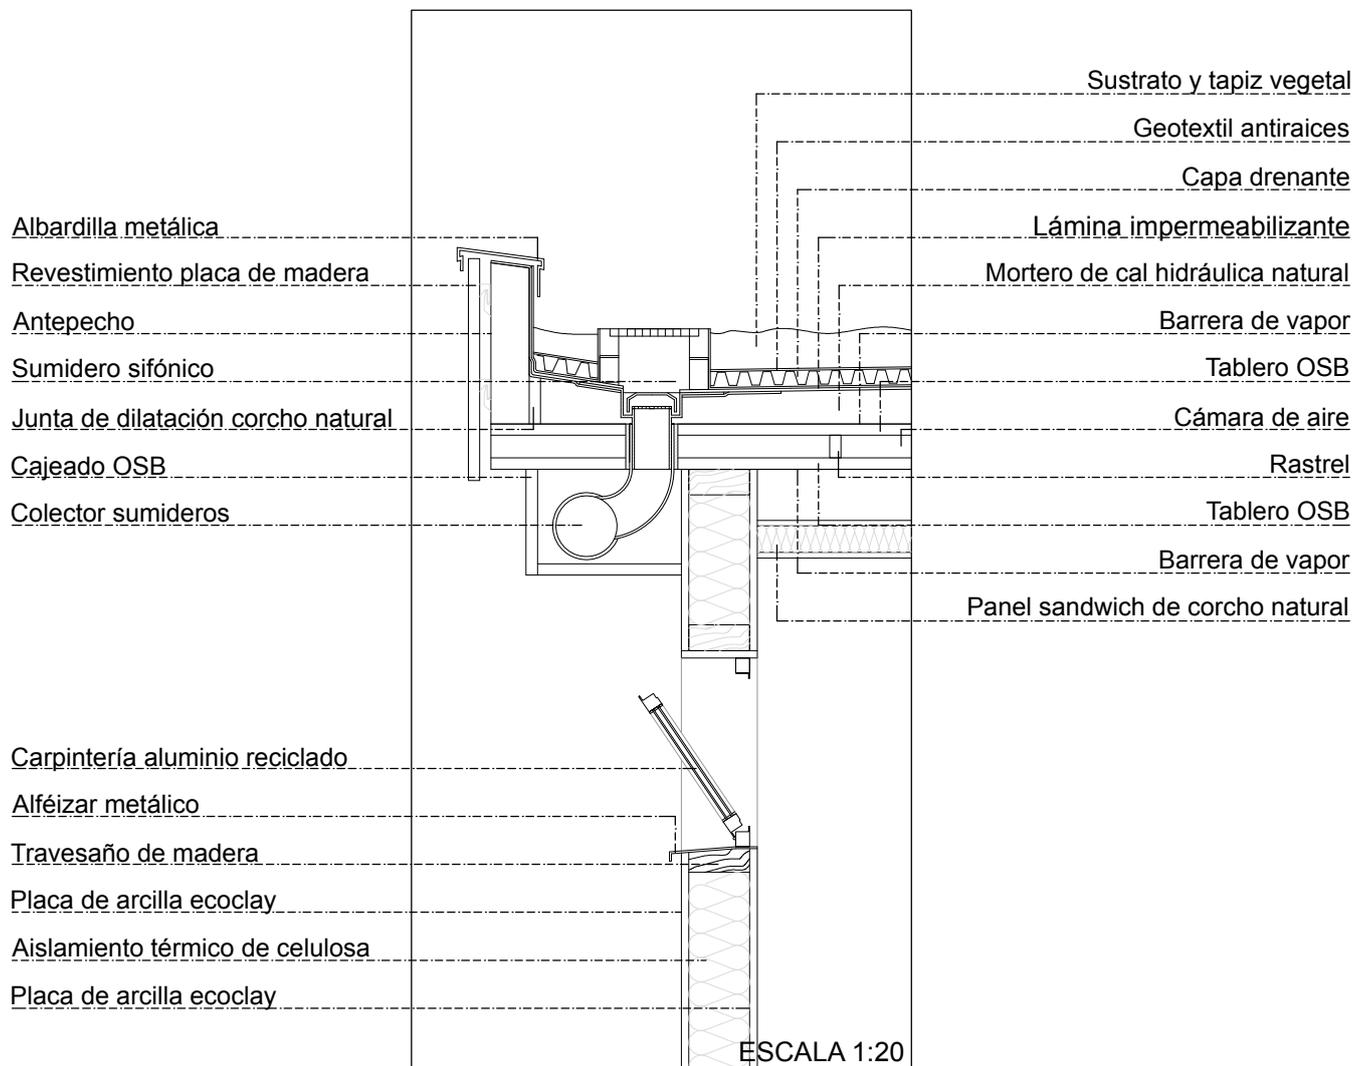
Detalle constructivo: cubierta. 2018. Fuente propia.
